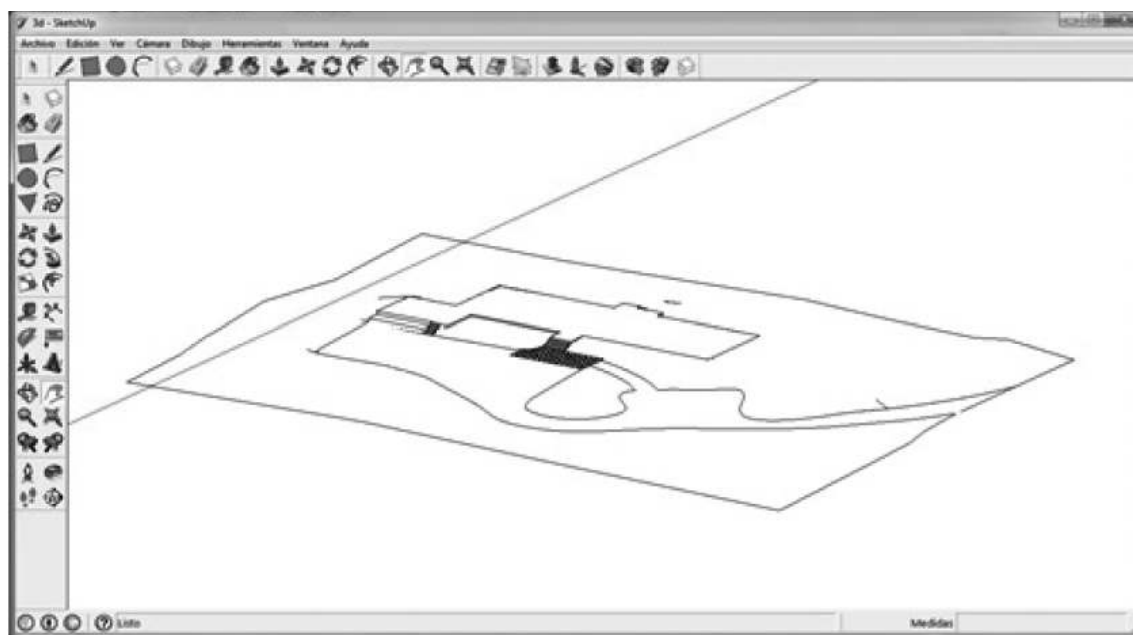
SKETCHUP / PERÍMETRO DE LA PLANTA EN EL SITIO / ELABORACIÓN PROPIA.
